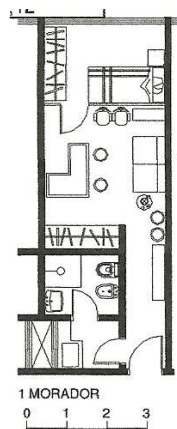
Planta baixa de apartamento do bloco B (Fonte: GALVÃO e ORNSTEIN, 2008, p.7)
